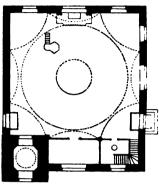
St. Mary's Abchurch zu London, Grundriss.
